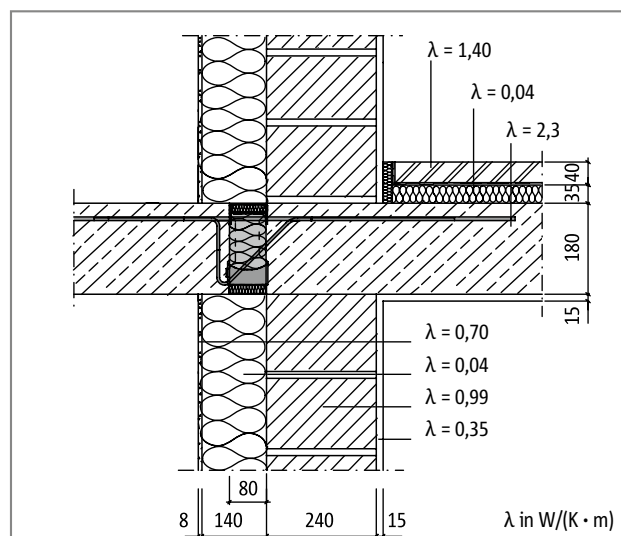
Raccordo della soletta del balcone con Schöck Isokorb® Tipo K50S con isolamento a cappotto e pietra arenaria calcarea
